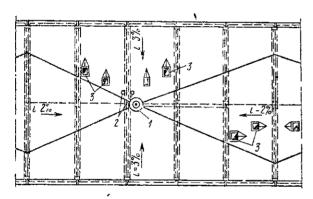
Фрагмент плана бесчердачной крыши 1 — водосток, 2 — канализационные стояки 3 — вентиляционные шахты
